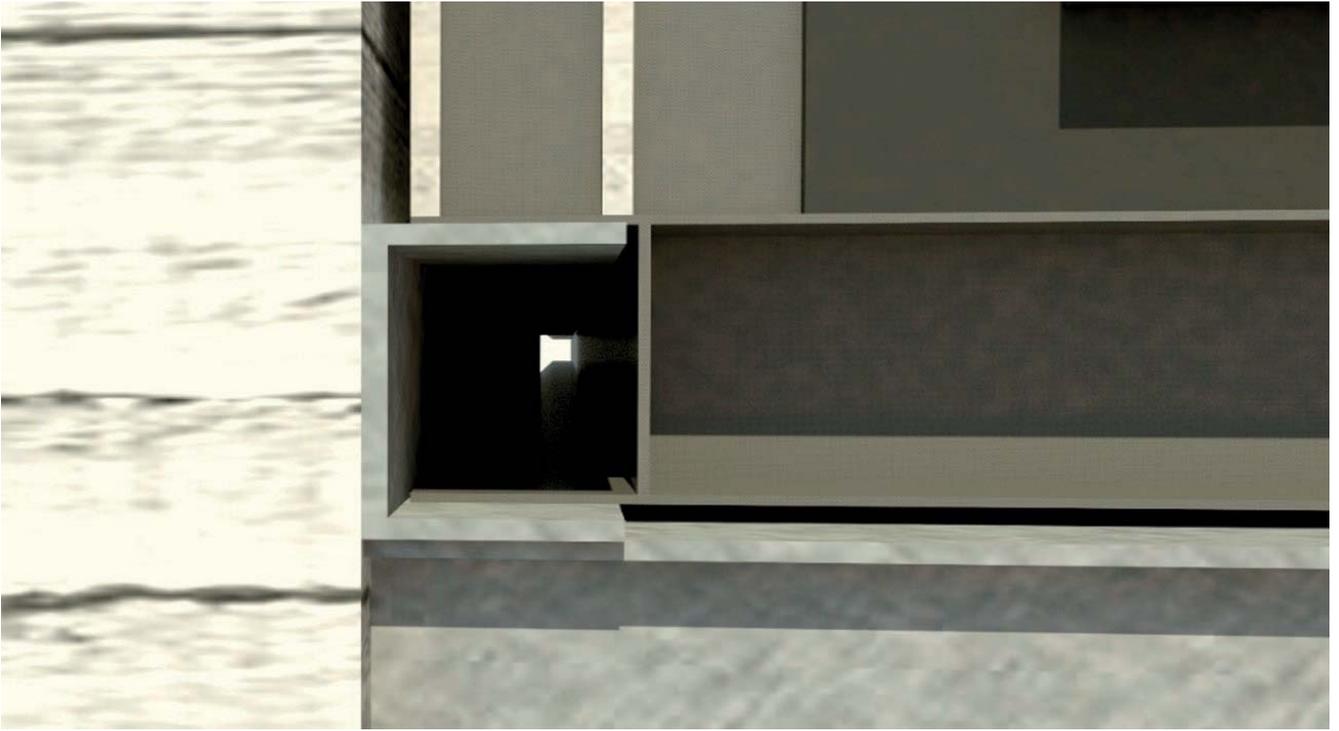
Los perfiles del Hábitat.uno se deslizan y apoyan en el canal CE.
